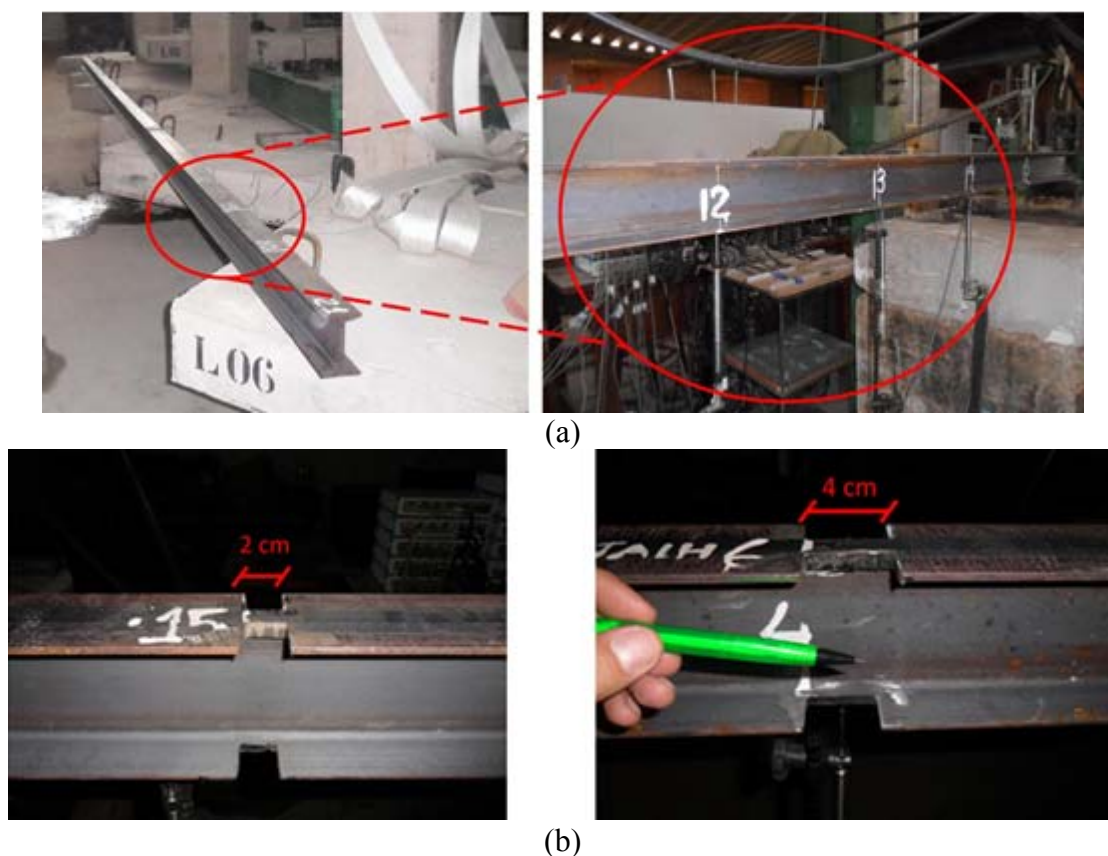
Panorama das vigas: (a) demonstração da viga em 16 elementos e (b) danos induzidos de 2cm e 4cm (Palechor, 2013)
